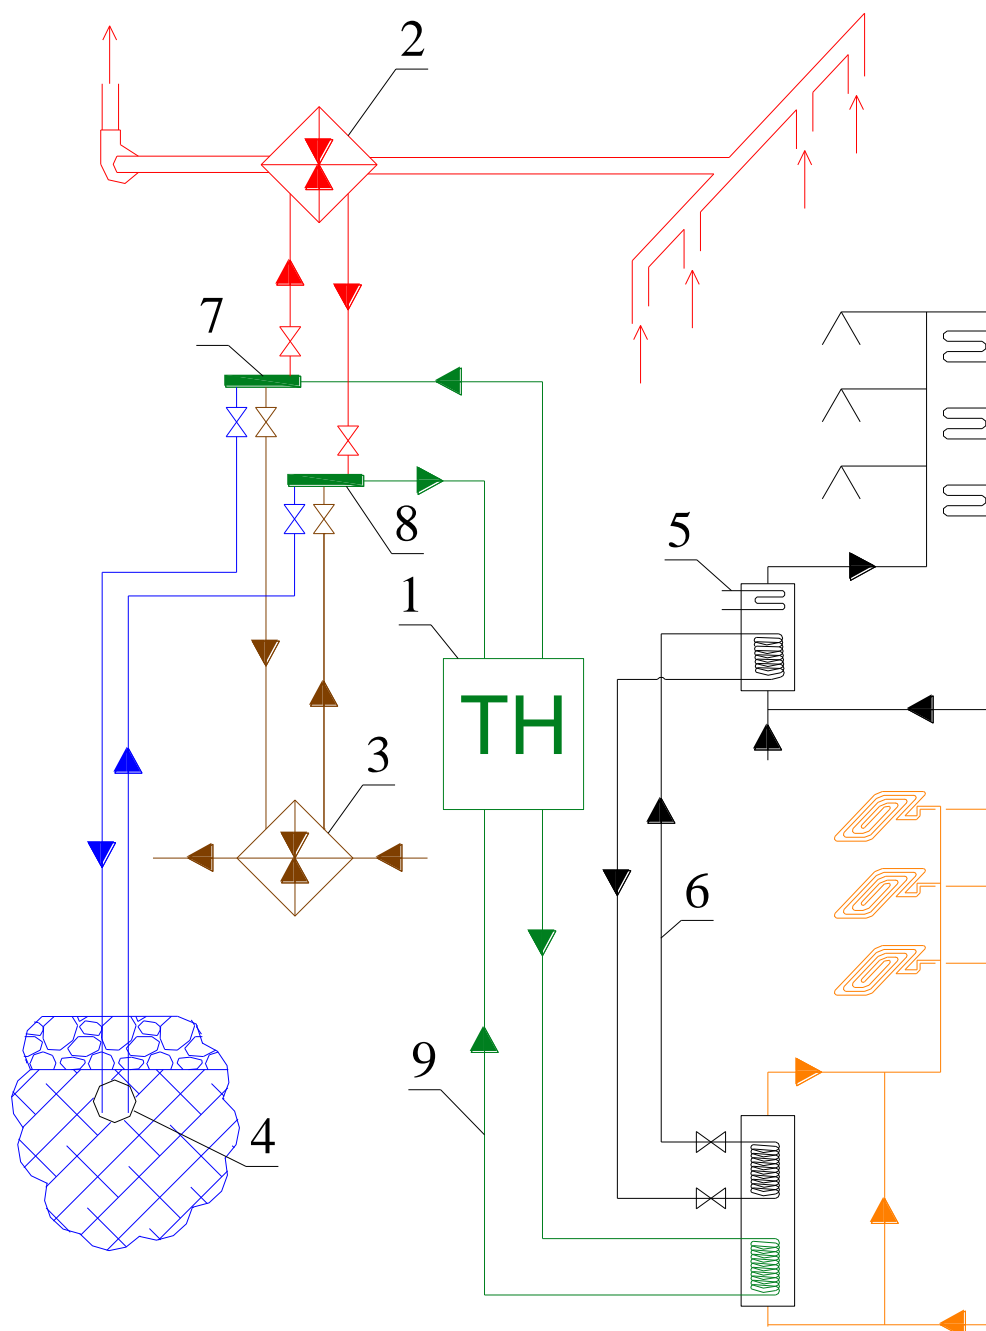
Принципиальная схема (избыточная) теплонасосной системы теплоснабжения здания с использованием собственных ИНТ:
